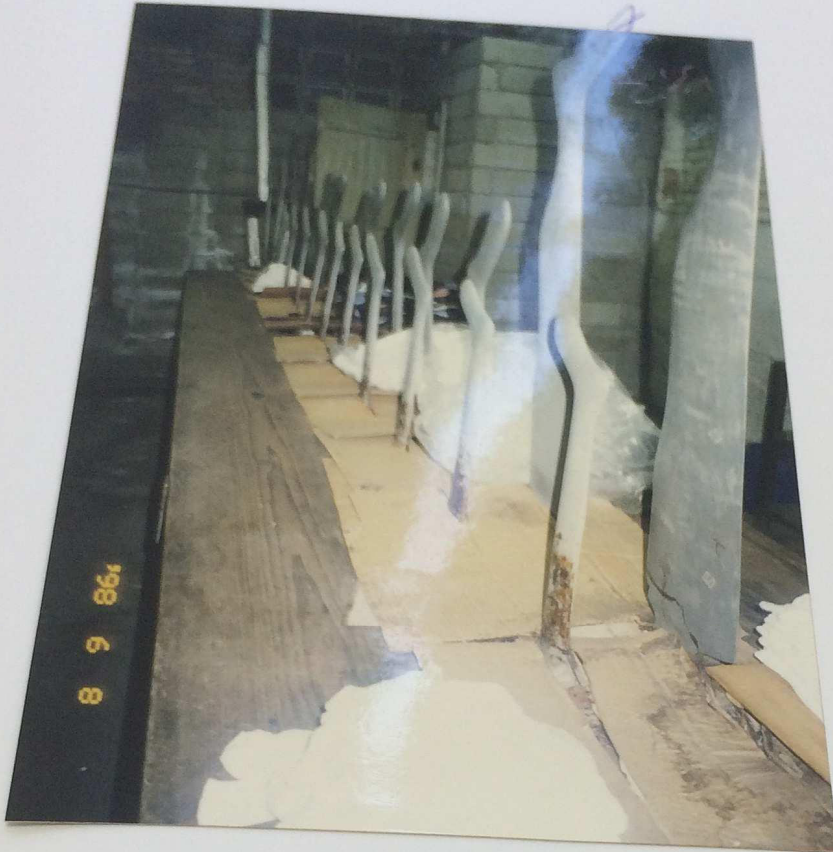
Vista parcial das áreas da edificação No. 2 do imóvel avaliando
